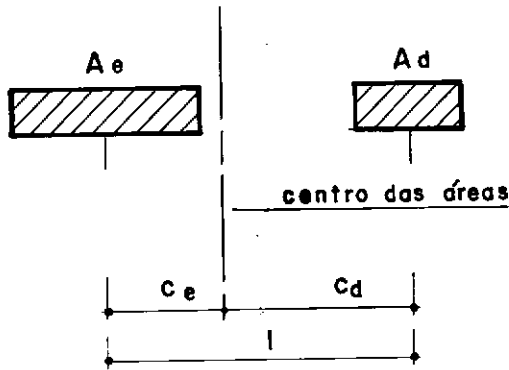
CENTRO DE GRAVIDADE DO CONJUNTO DE ÁREAS DOS PILARES - PAREDE
